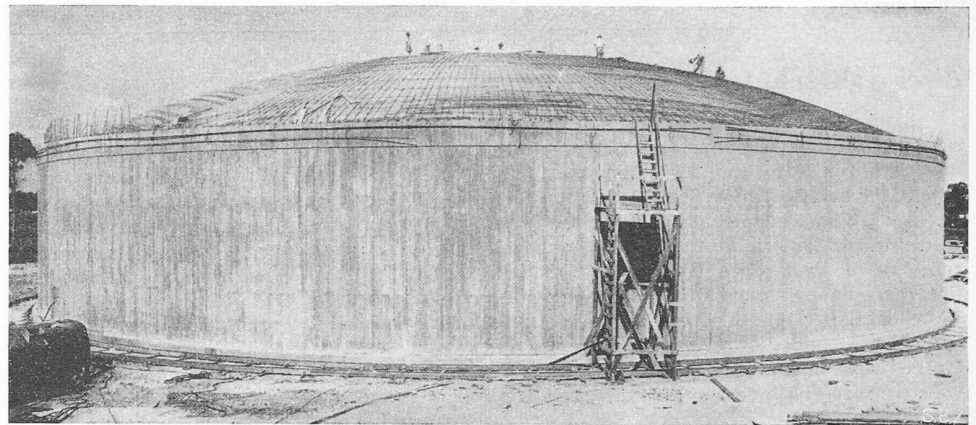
Behälter Bild 4 im Bau, Wand betoniert, aber noch nicht vorgespant, Kuppel eingeschalt, provisorisches oberes Zugband in Montage. Man beachte die mit Muttern versehenen, oben aus der Zylinderwand herausragenden vertikalen Armierungseisen
